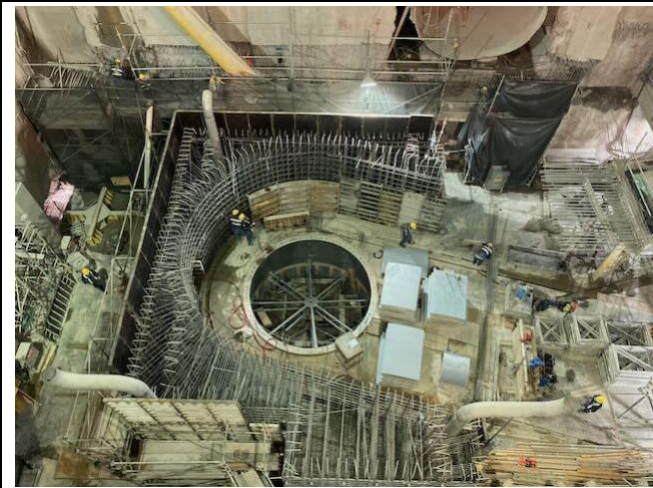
Trabajos de concreto en caverna de casa de máquinas
